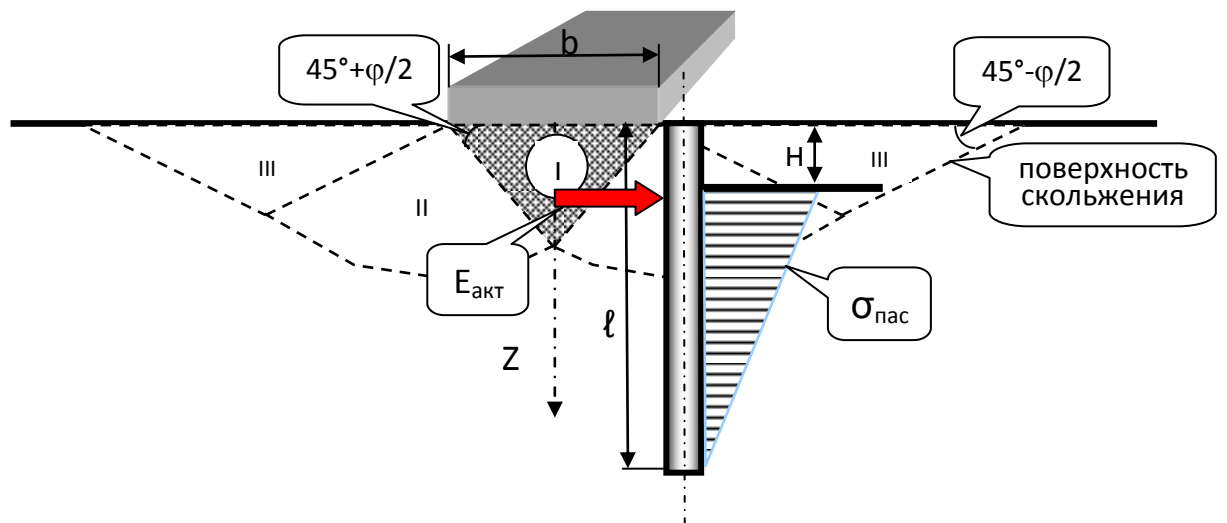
Расчётная схема формирования предельного состояния от ленточного фундамента для основания усиленного выштампованными микросваями.
